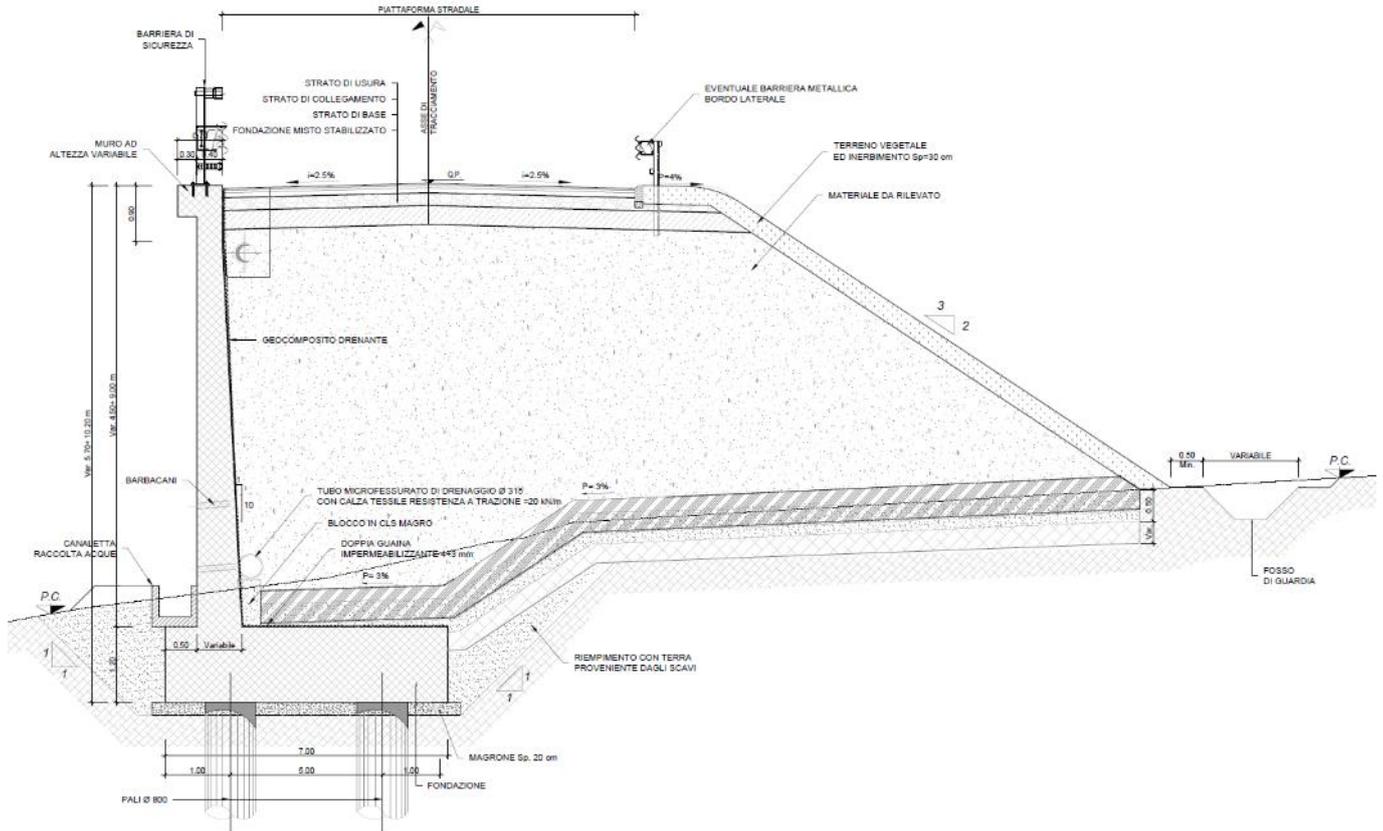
Sezione tipo in rilevato con muro di sostegno (tipo ST-2)
